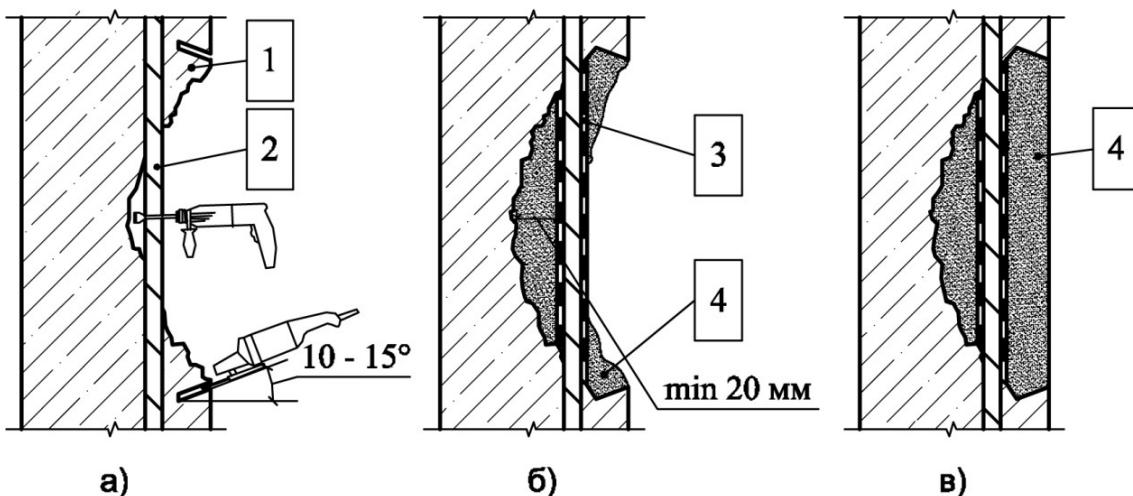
Схема ремонта дефектов бетона с оголением арматуры:
